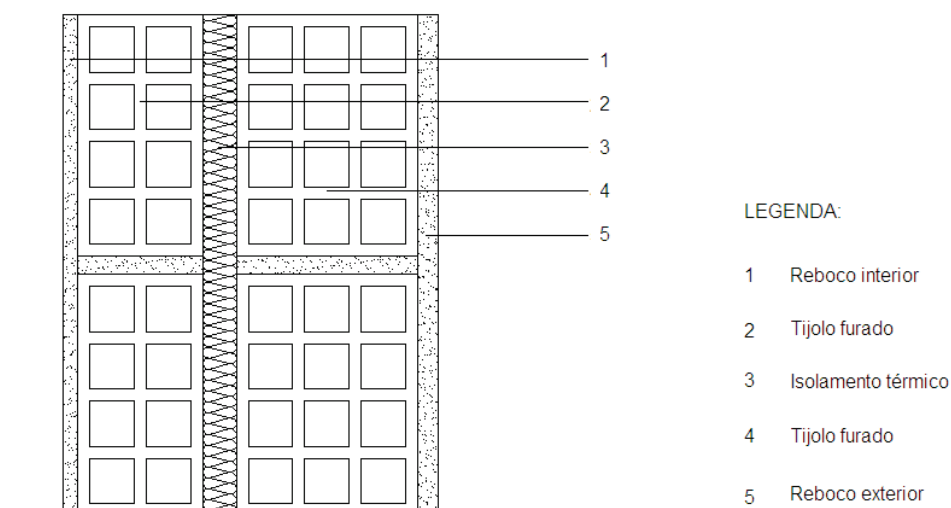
Pormenor construtivo da parede dupla com isolamento térmico no interior.
